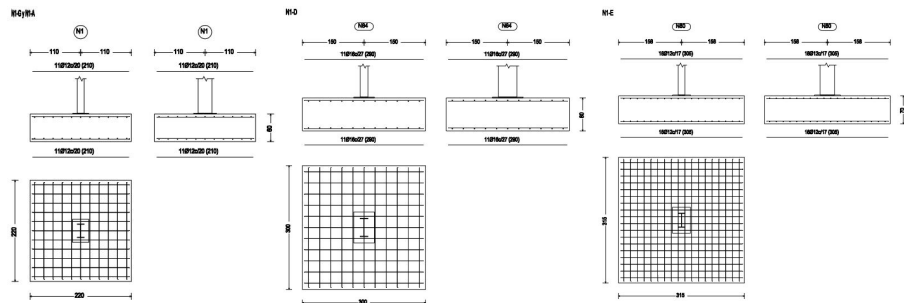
Zapata tipo D (izquierda), Zapata tipo E (centro) y Zapata tipo G (derecha)
